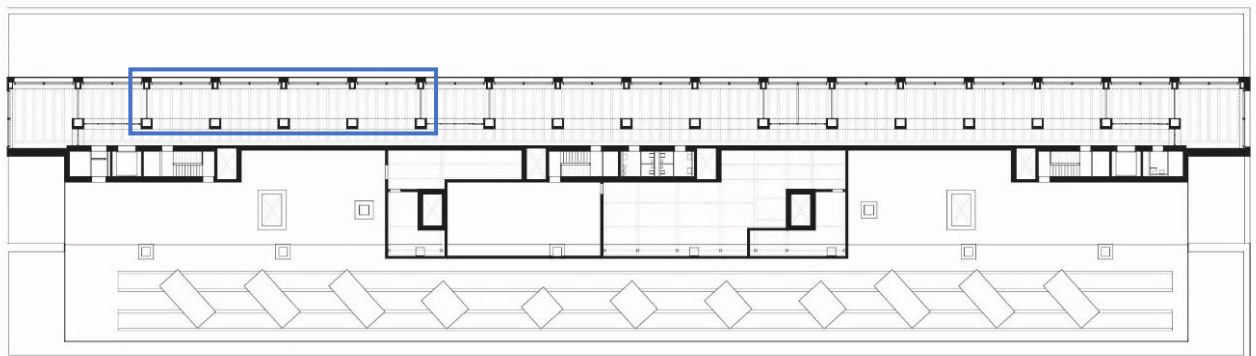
Campus SUPSI, Mendrisio - 4° piano
